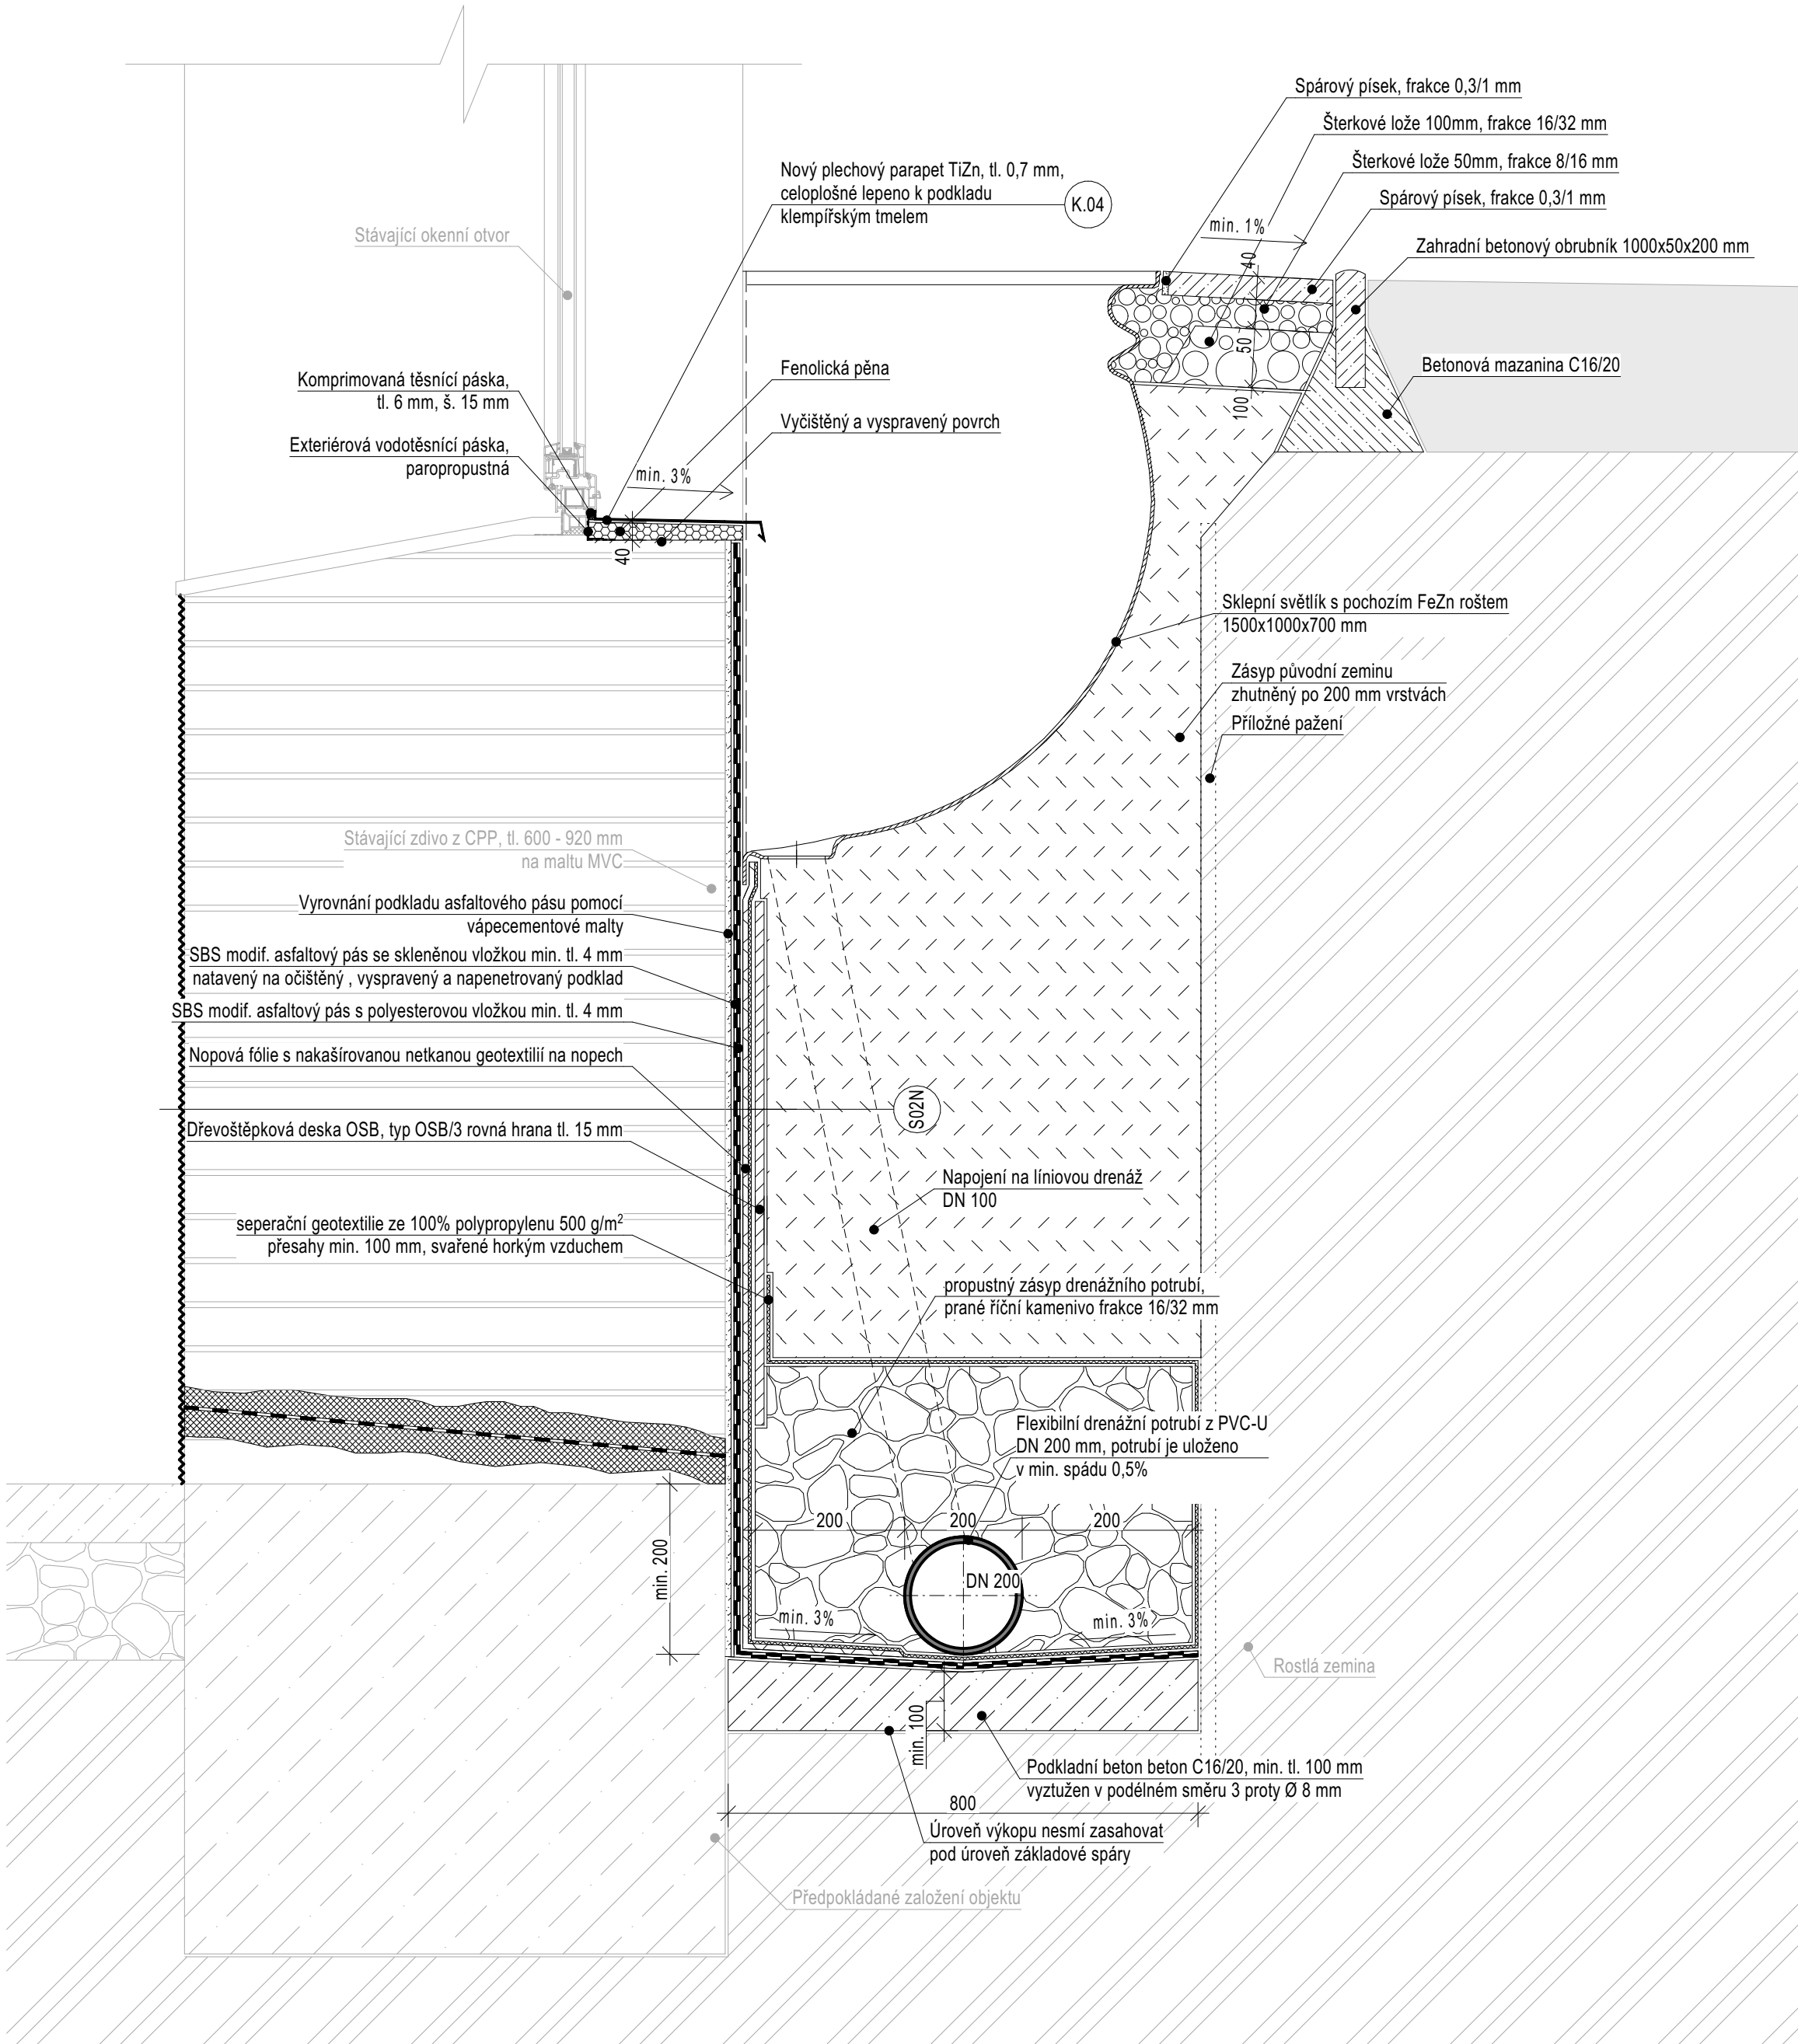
DETAIL F - SKLEPNÍ SVĚTLÍK, M 1:10
